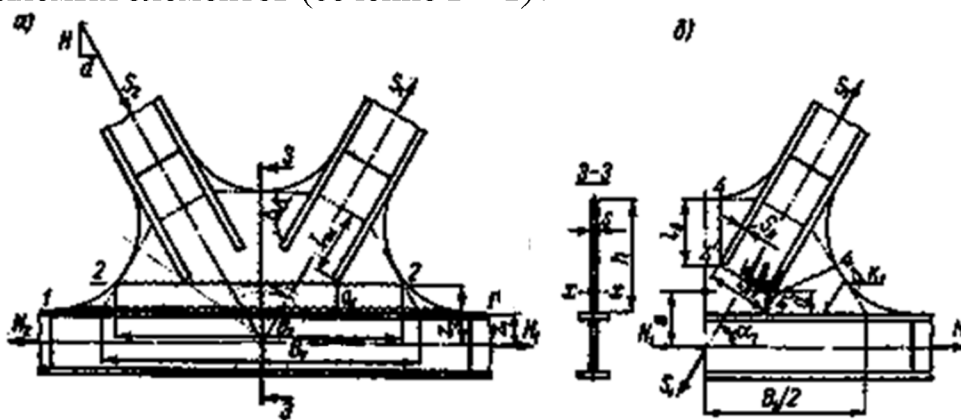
Узел сварной фермы (а) и его расчетные сечения (б)
